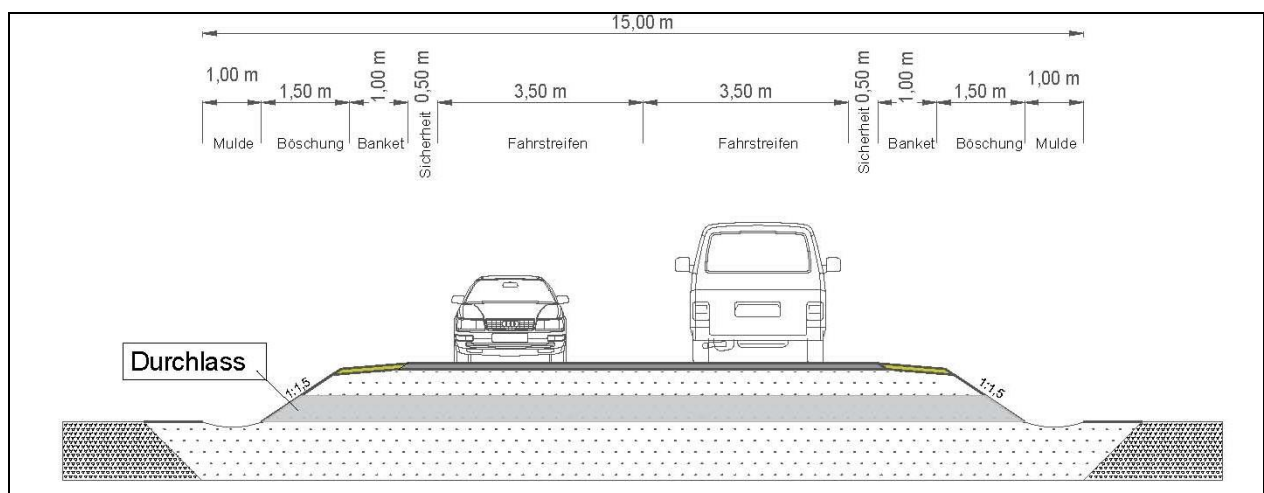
Querschnitt Dammbauwerke - Bereich NSG
